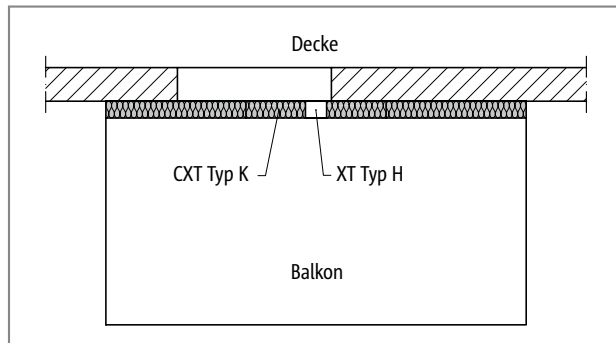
Schöck Isokorb® CXT Typ K: Balkon frei auskragend; optional mit XT Typ H bei planmäßigen Horizontallasten (z. B. geschlossene Brüstungen)
